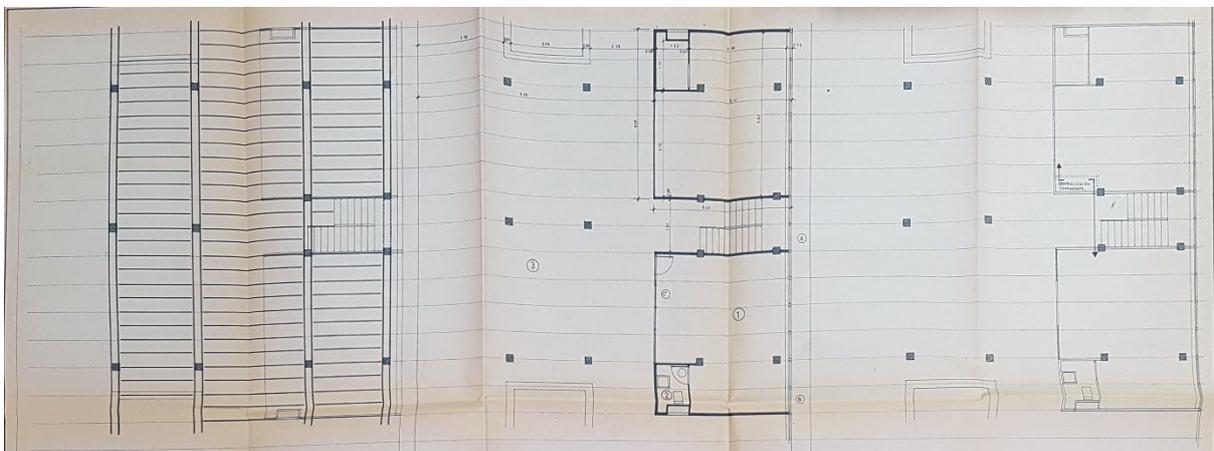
Planta tipo local comercial en galería. 1964. Fuente: Archivo Municipal da Coruña
